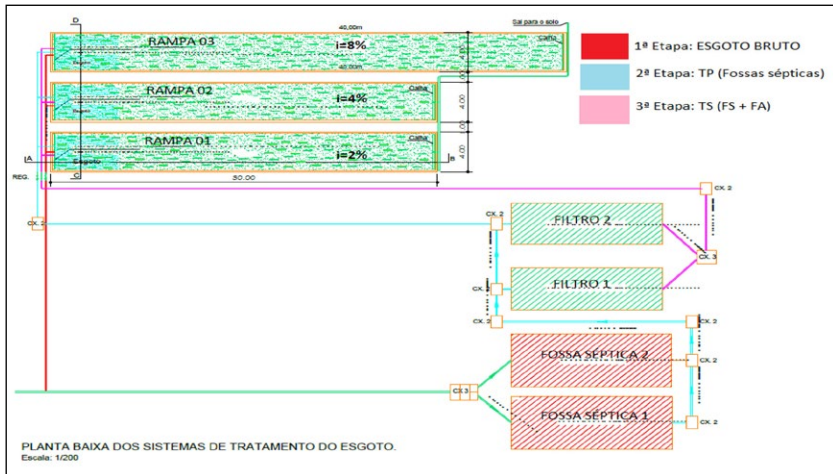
Planta baixa dos sistemas de tratamento de esgoto – ETE Santa Maria.
